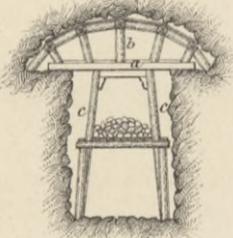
Hauenstein-Tunnel. (1853-1857).
